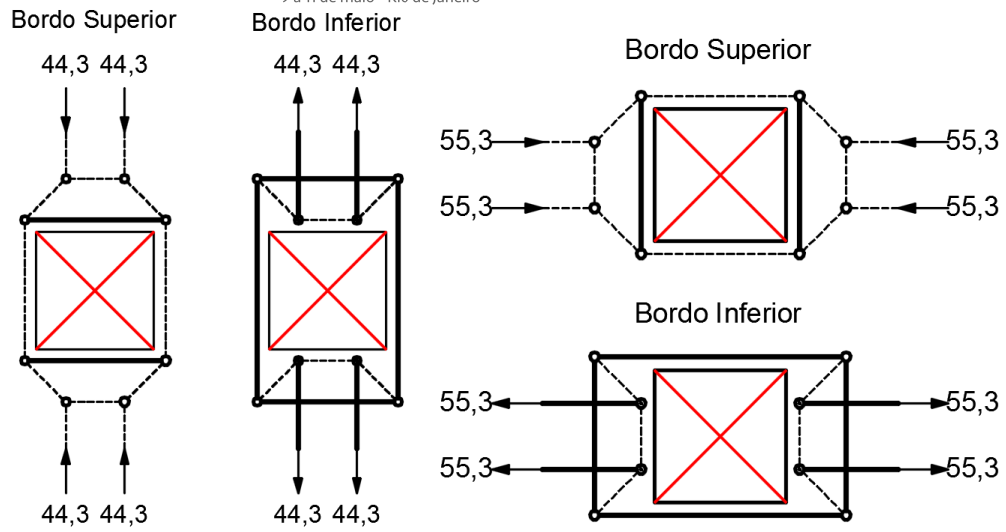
Modelos vertical e horizontal de bielas e tirantes, aberturas em lajes
